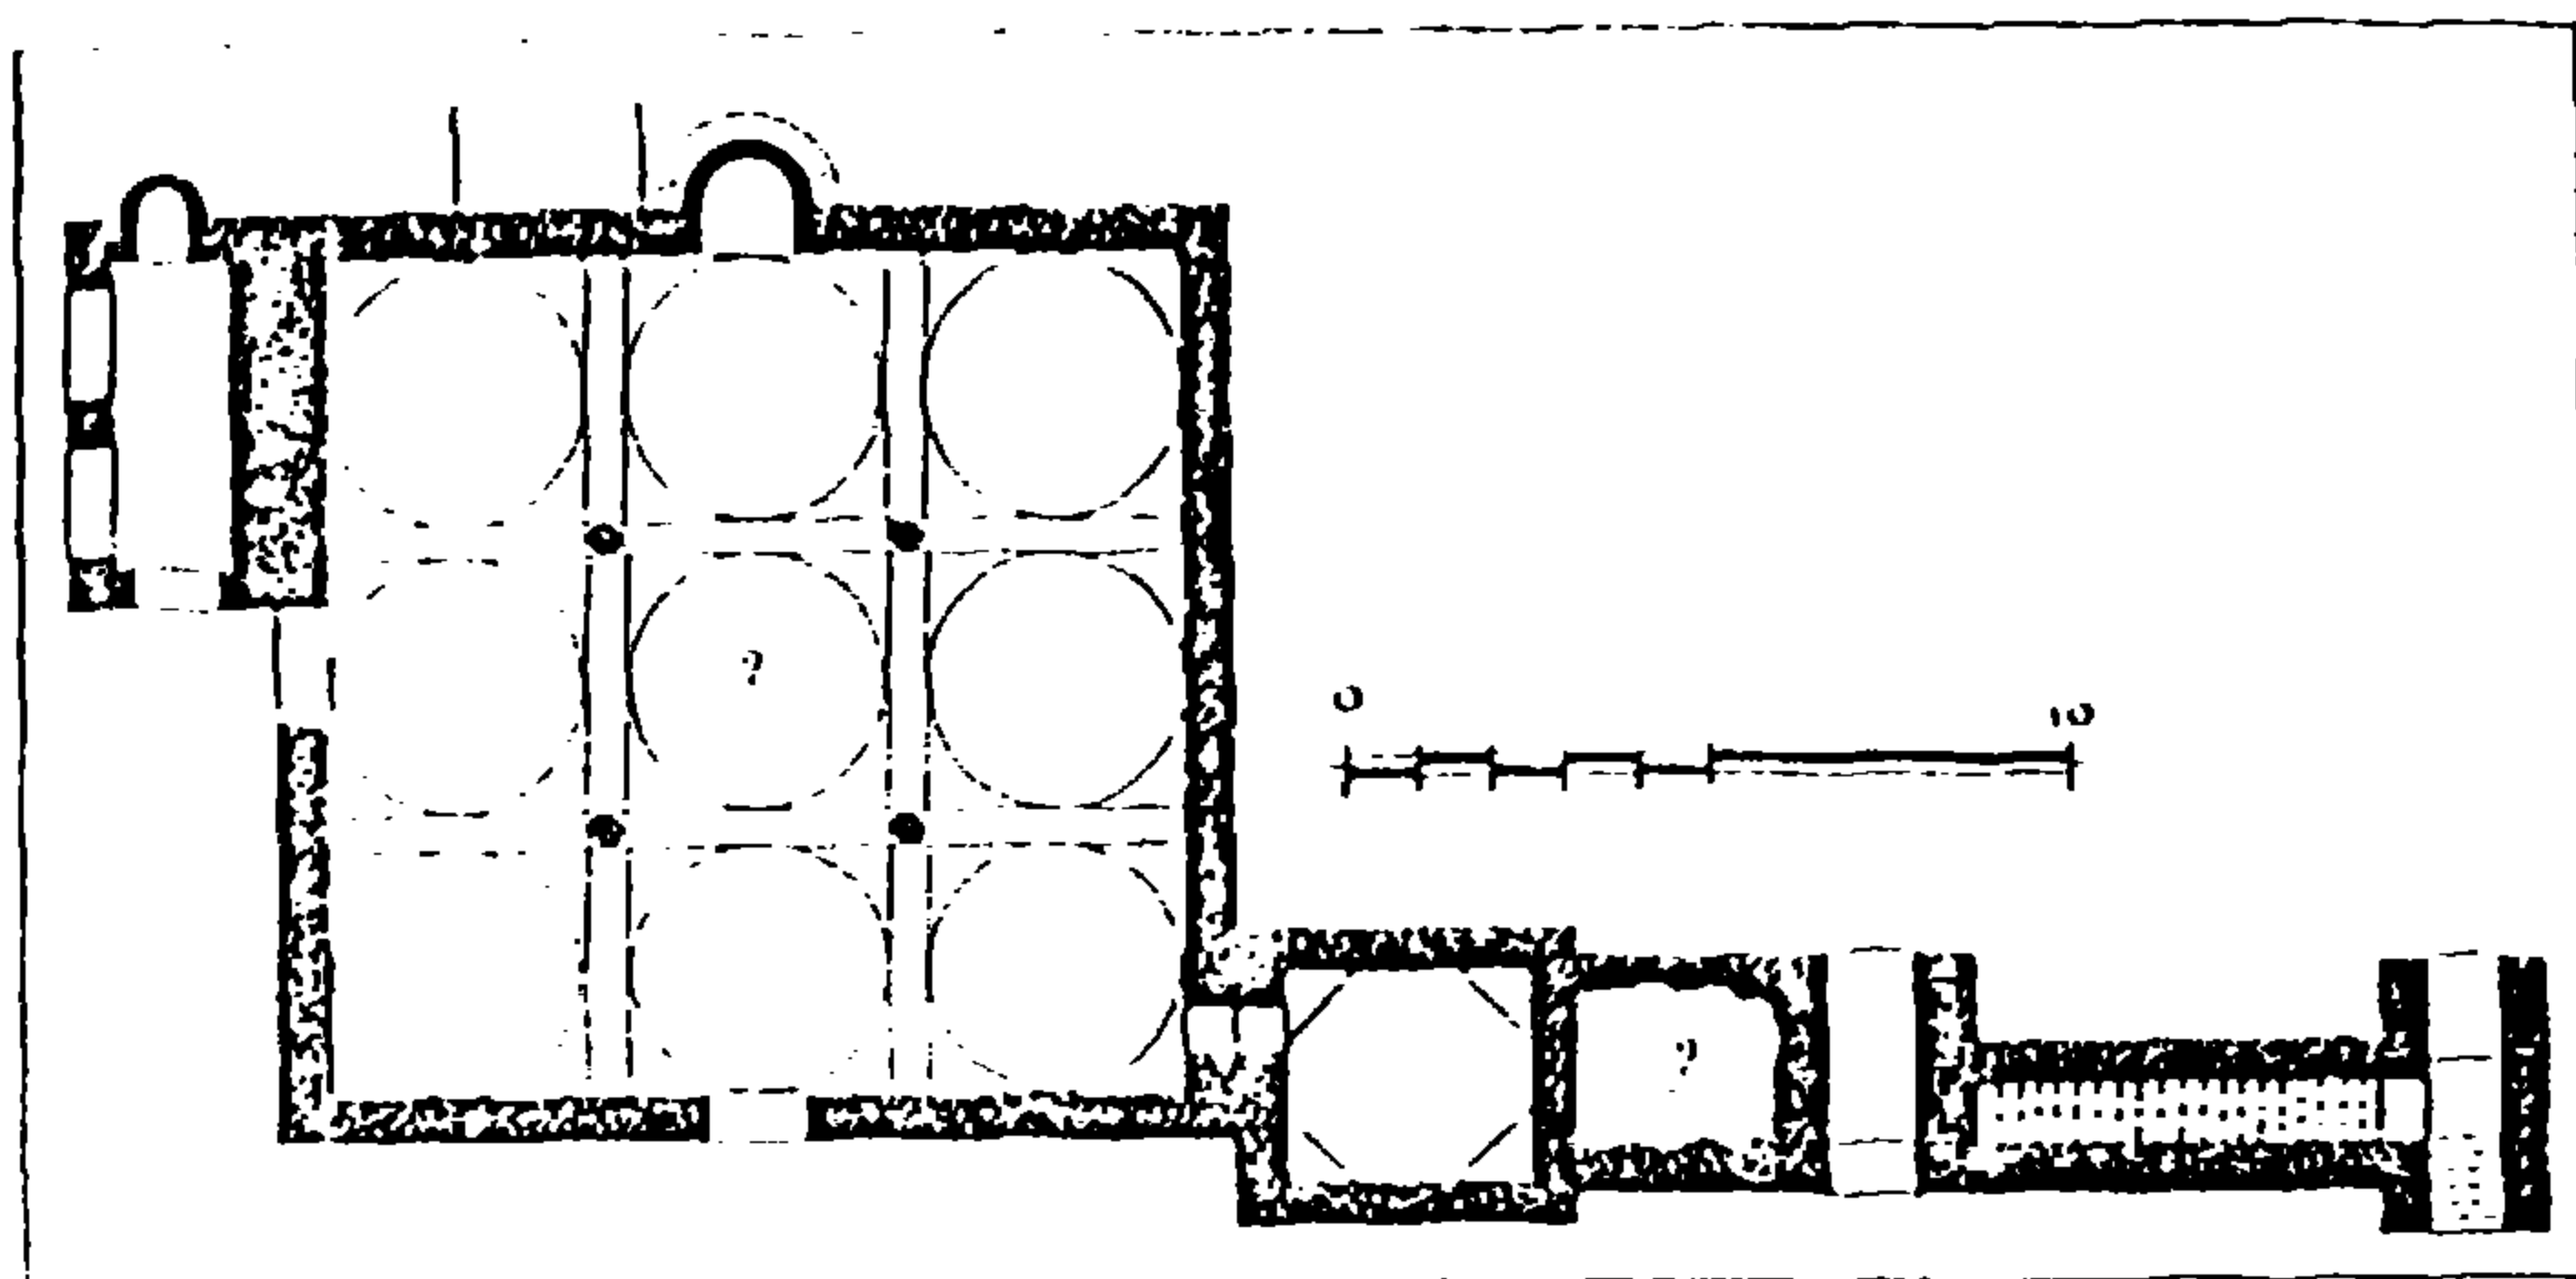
المسقط الأفقى لجامع محمد أبو الذهب
